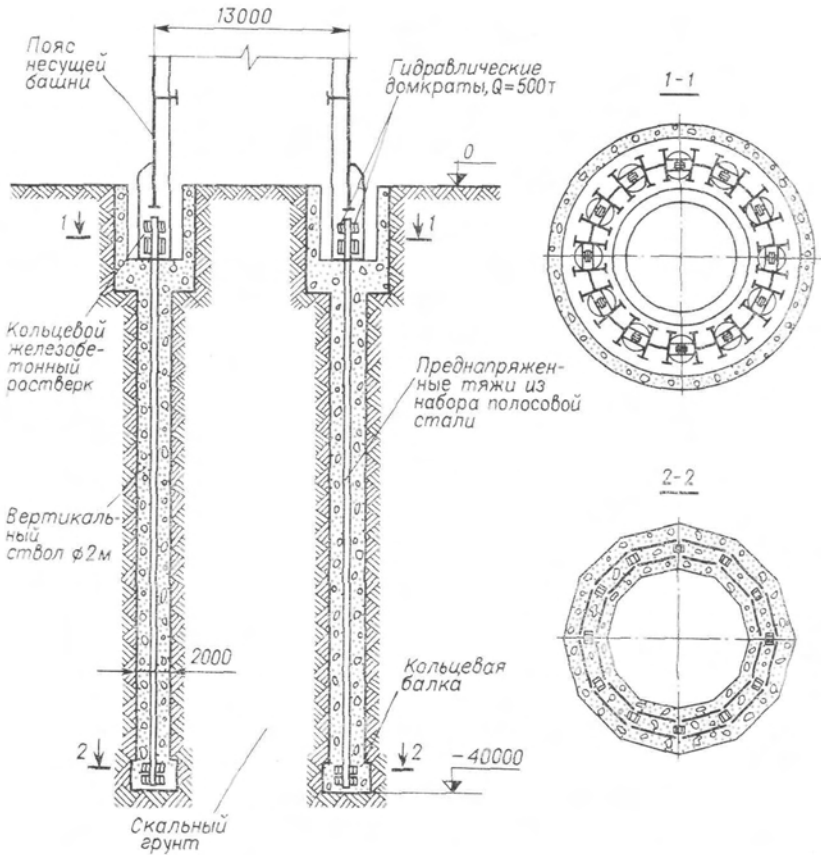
Принципиальное решение опорного узла пояса башни высотой 600 м
